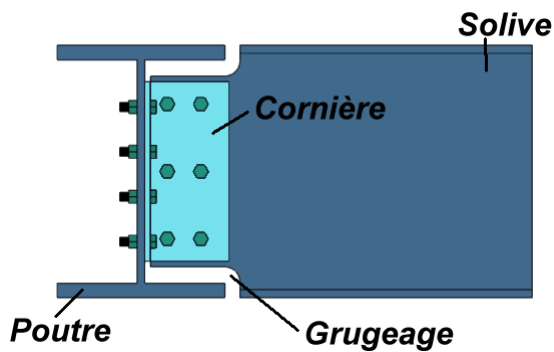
Articulation poutre-solive par cornières boulonnés sur l'âme de la poutre - vue de côté
